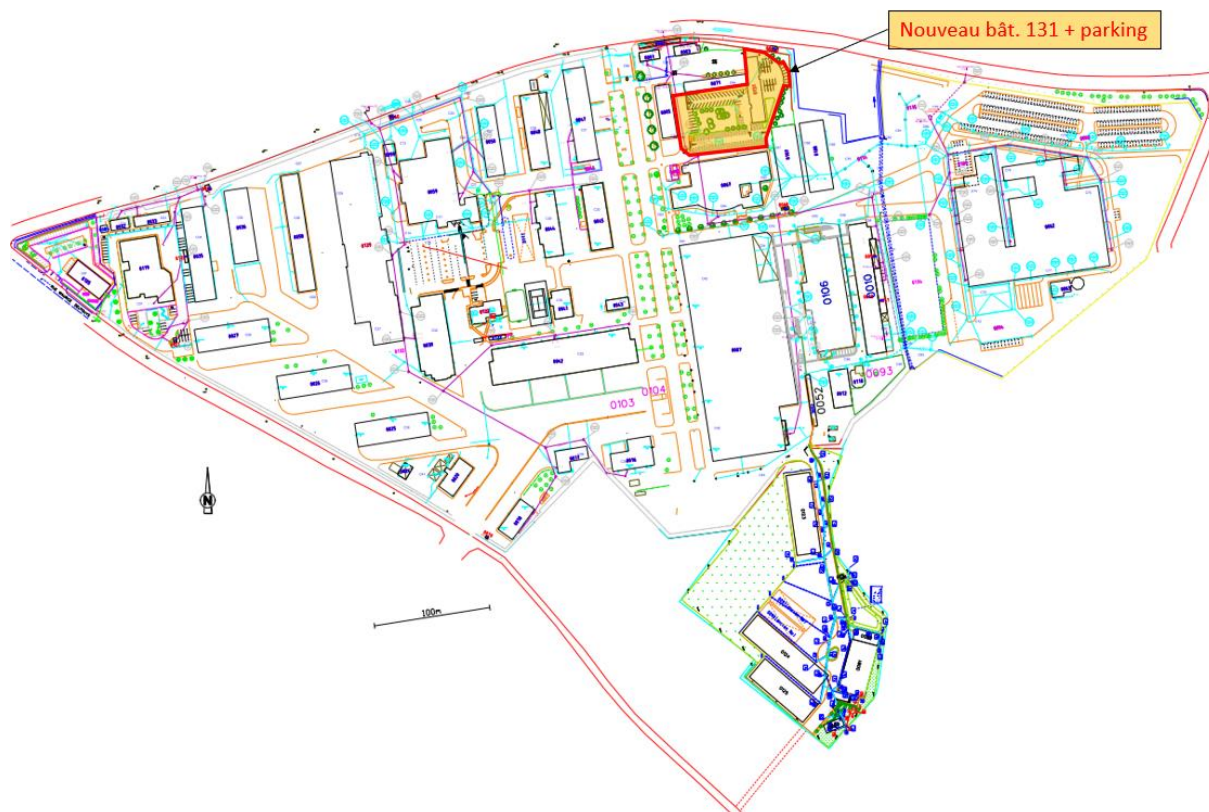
Plan général des réseaux eaux pluviales du site du Quartier Vergnes
